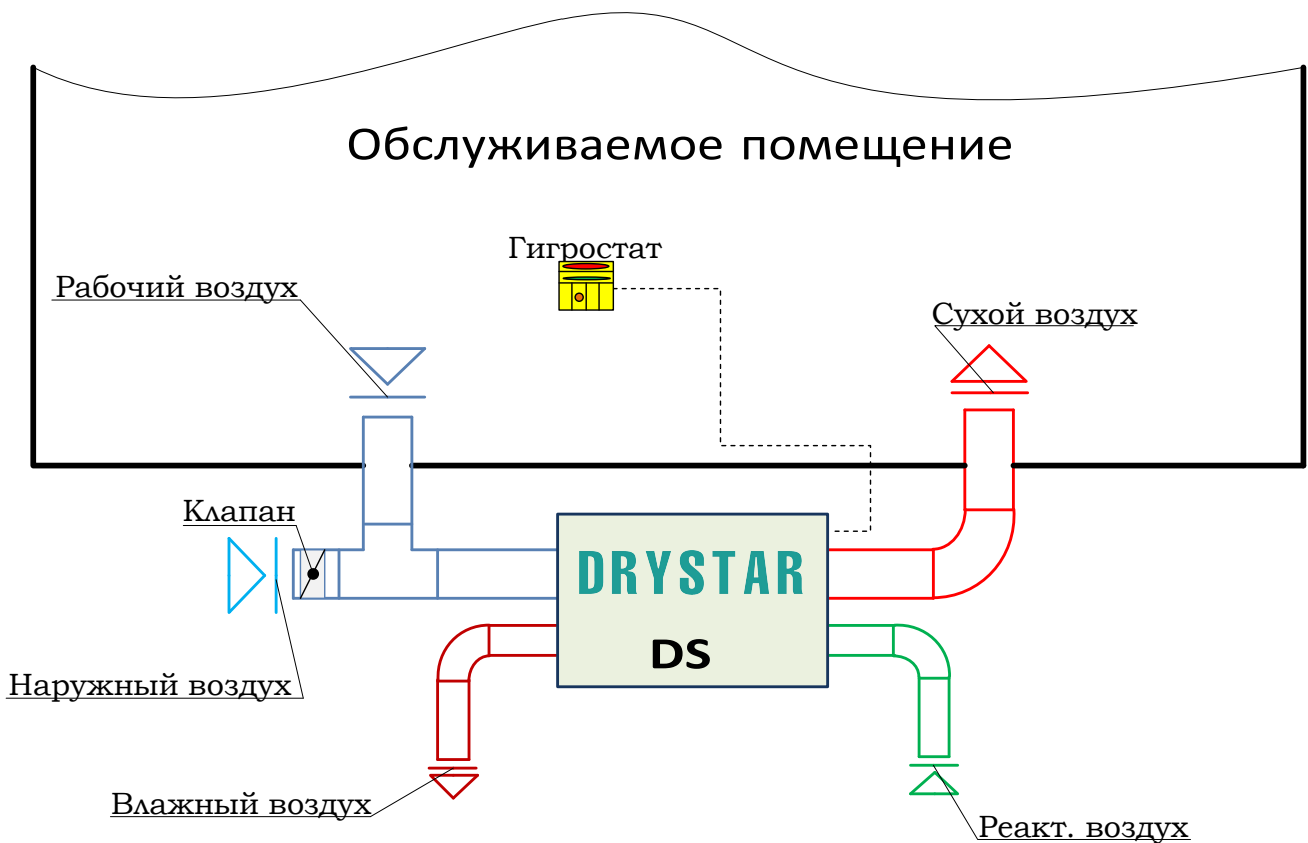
Работа осушителя по «закрытой» схеме с подмесом свежего воздуха
